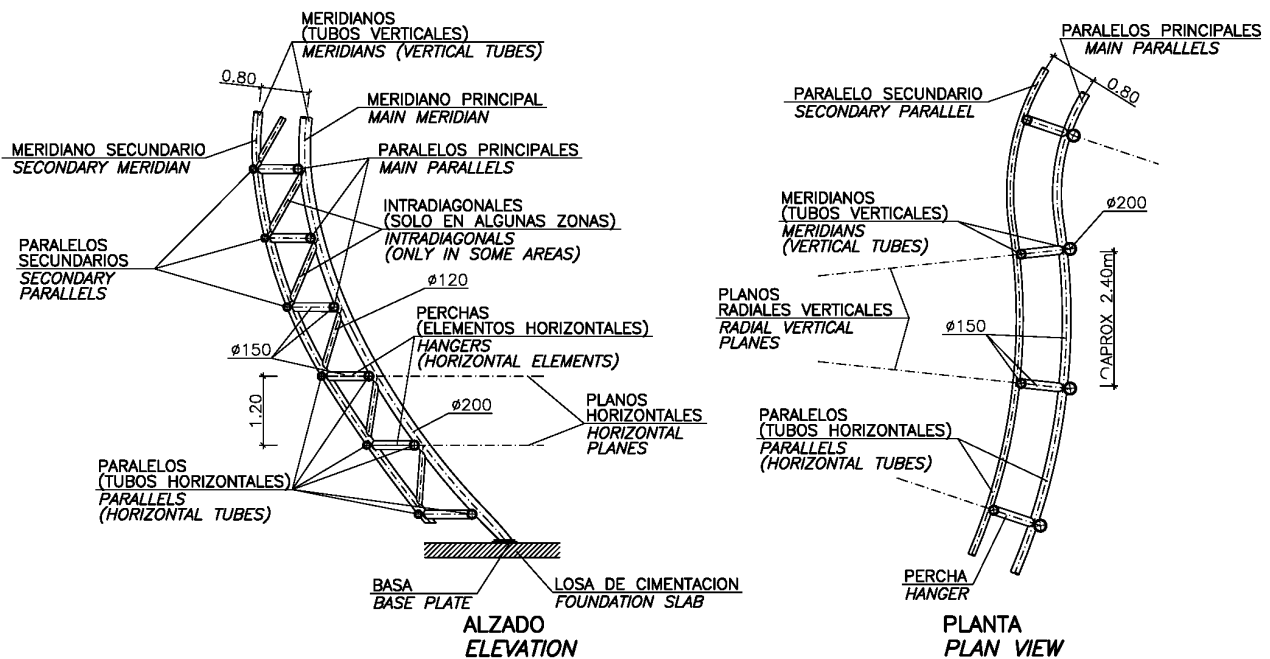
Estructura de fachada, compuesta por una doble malla ortogonal de tubos curvos. La malla principal se extiende hasta la cimentación, mientras que la malla secundaria se vincula a la principal por medio de “perchas”, y en algunos casos, “intradiagonales”.
